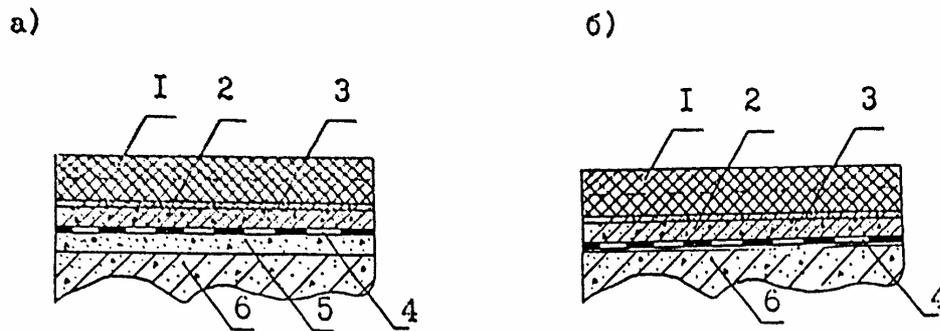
конструкция дорожного гидроизоляционного ковра на пролетных строениях
